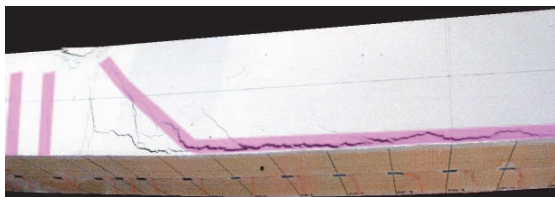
実験時における A1-T20 試験体のひび割れ状況
